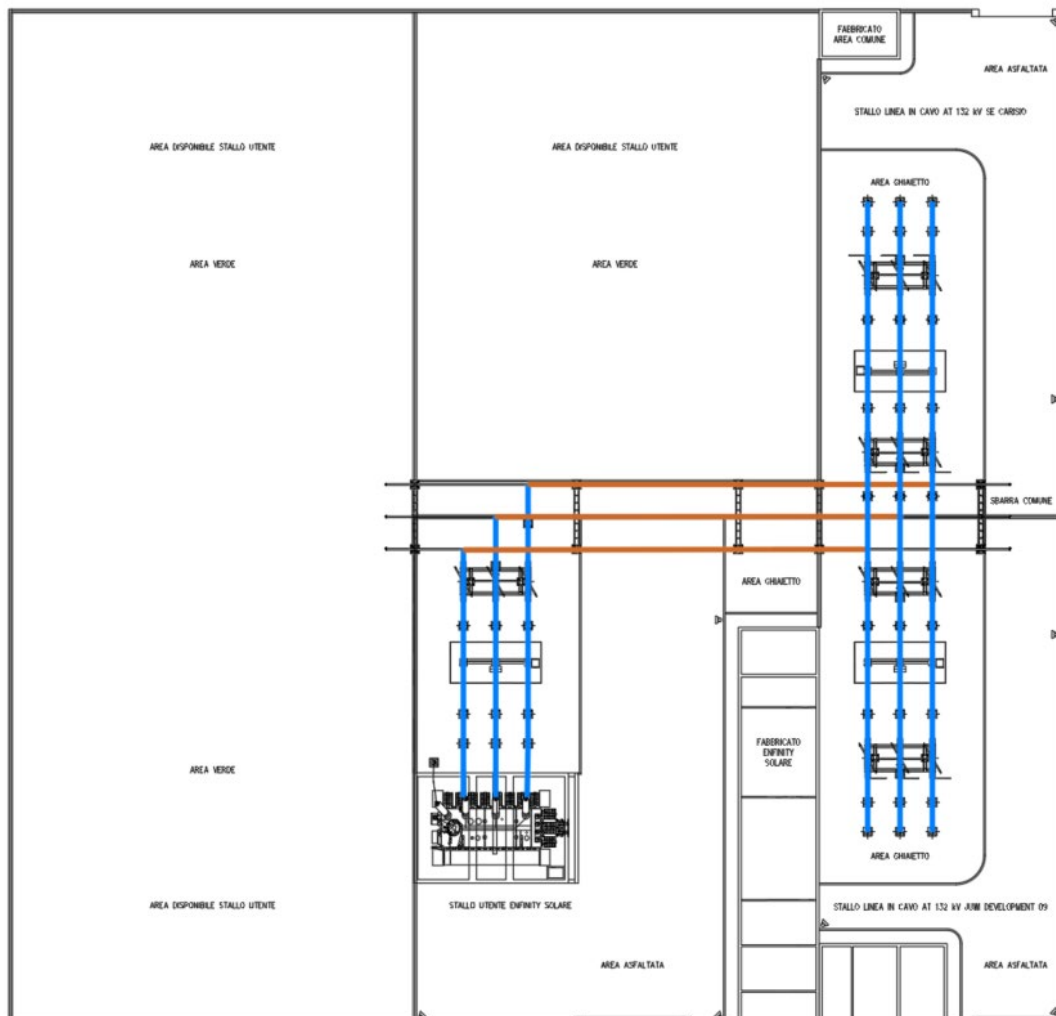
Planimetria del punto di raccolta con individuazione degli elementi attivi
